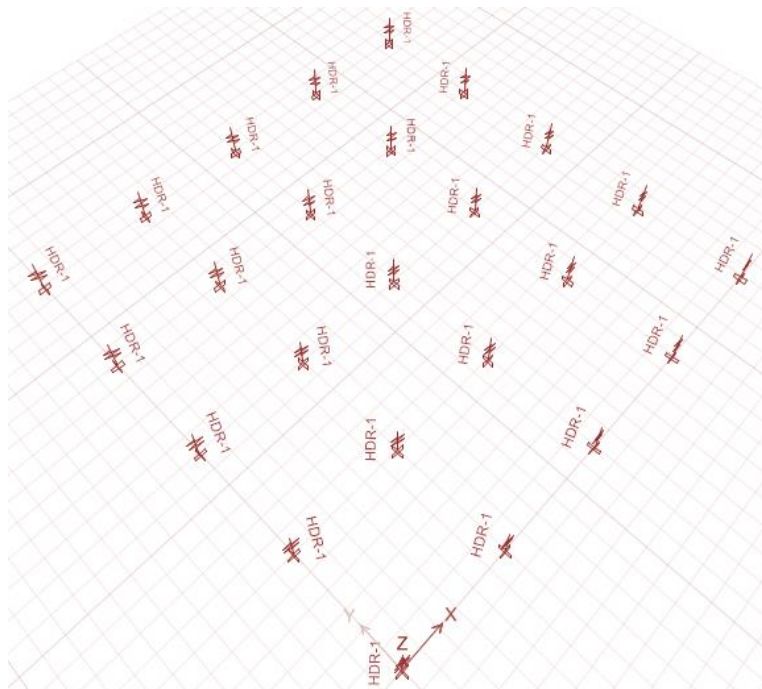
Distribución en Planta Aisladores tipo HDR (Microzona Lacustre 200). Fuente: Propia.
